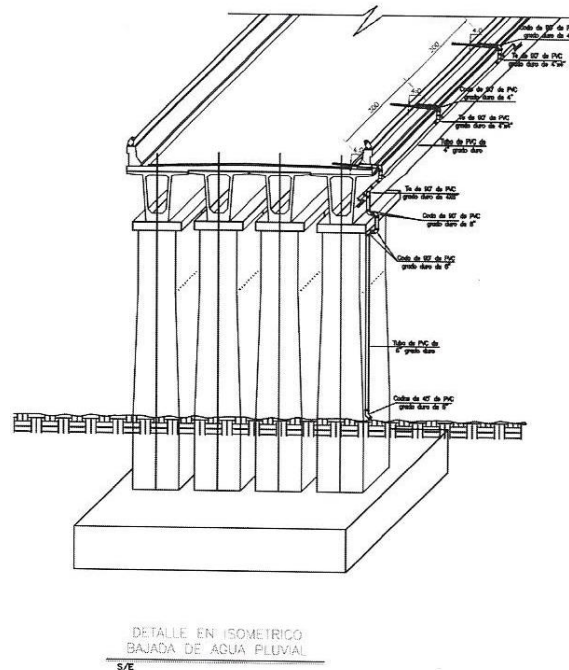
Isométrico de diseño de drenaje pluvial.
